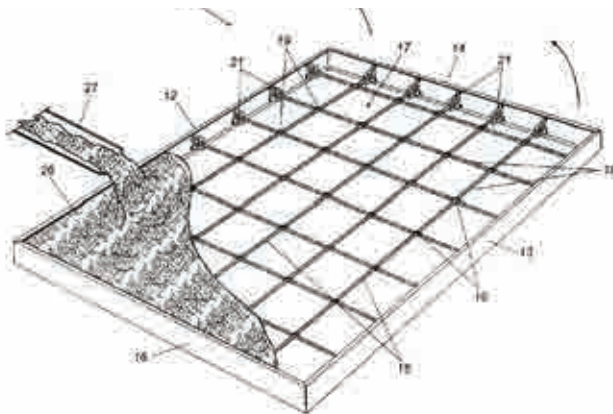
Patente 'Tilt-Up concrete wall panel form and method of fabricating same'.
